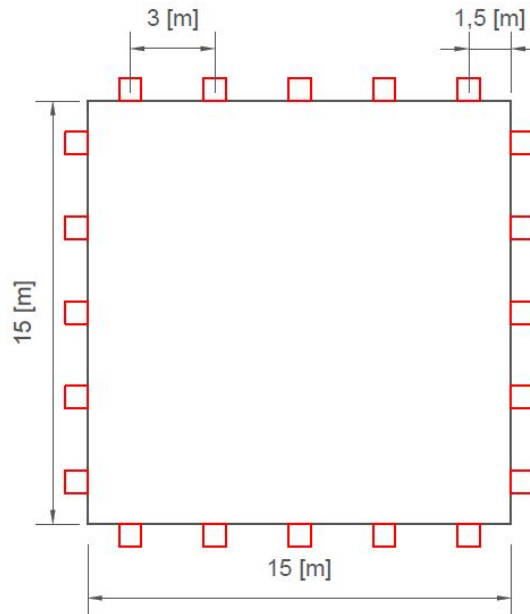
Vista en planta de excavación de área $225 \text{ [m}^2\text{]}$.
